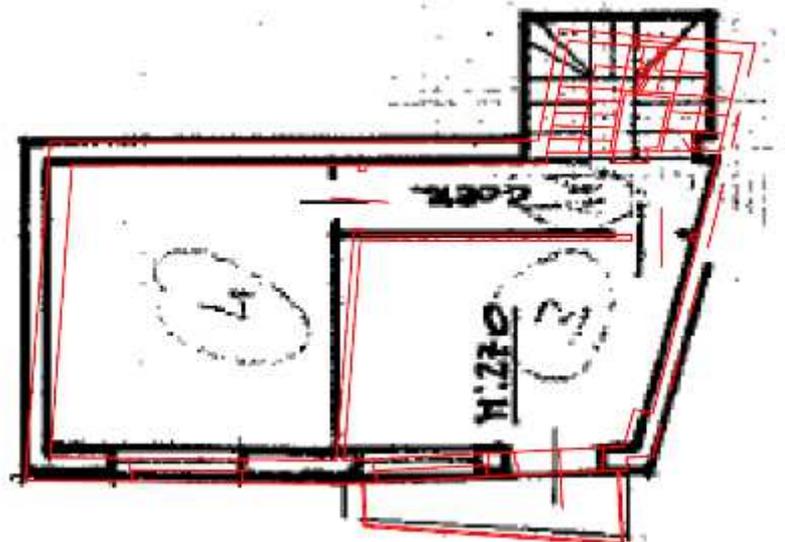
Sovrapposizione tra lo stato attuale - planimetria catastale, sub. 1 (p.2).
